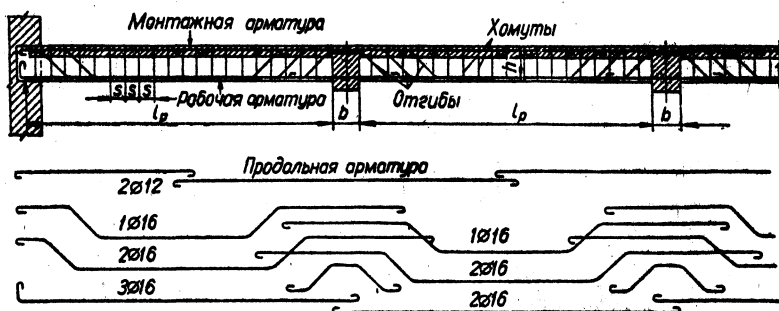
Армирование многопролетной второстепенной балки отдельными стержнями.
